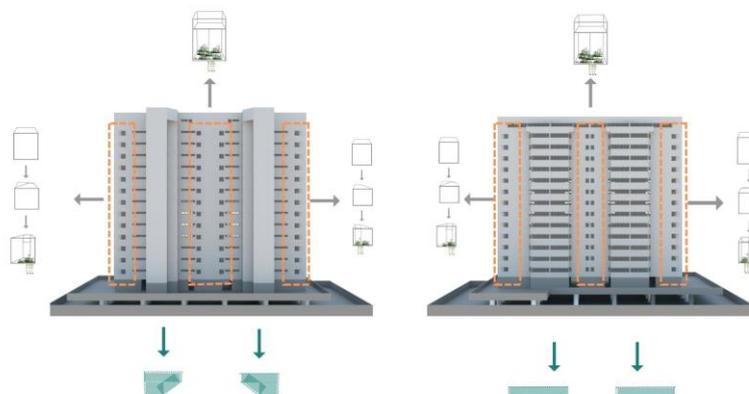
Edifício Villa Elizabeth - adições e subtrações dos planos das fachadas. Fonte: Adrião, 2023.
